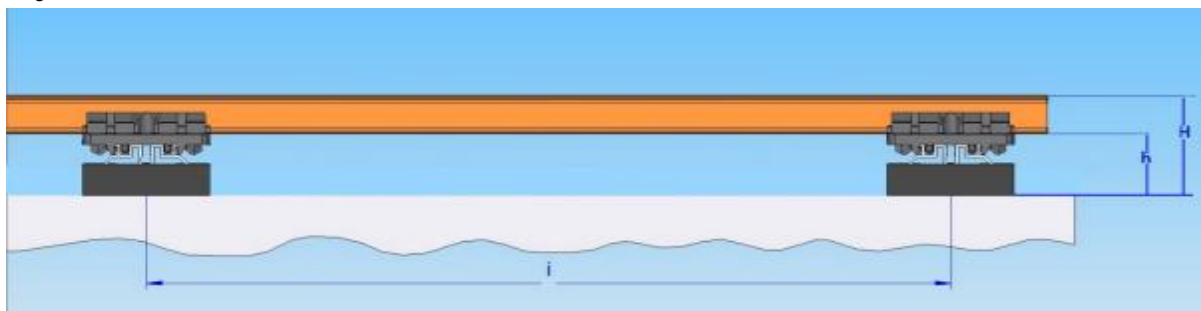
sezione trasversale dei listoni in legno fissati su sottostruttura in alluminio KIT 60 ad altezza fissa
